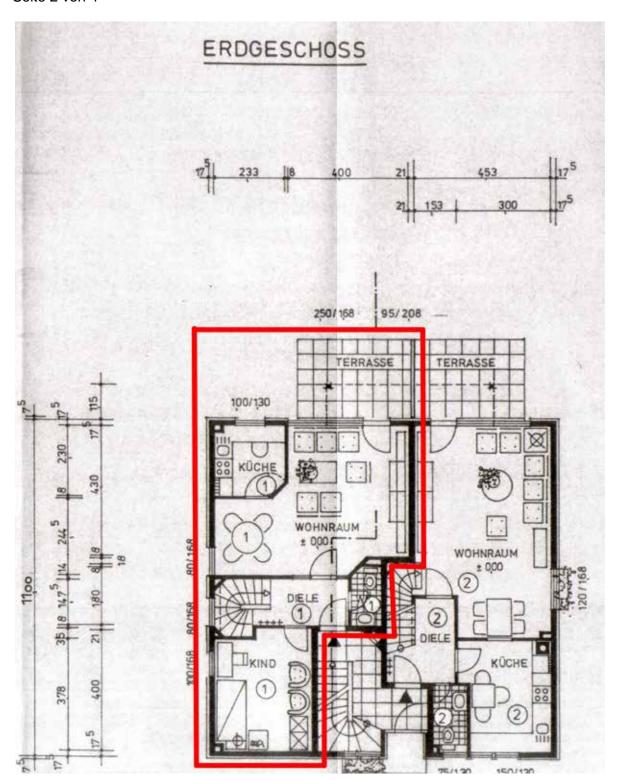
Grundriss des (mit Kennzeichnung der Lage des Sondereigentums)
